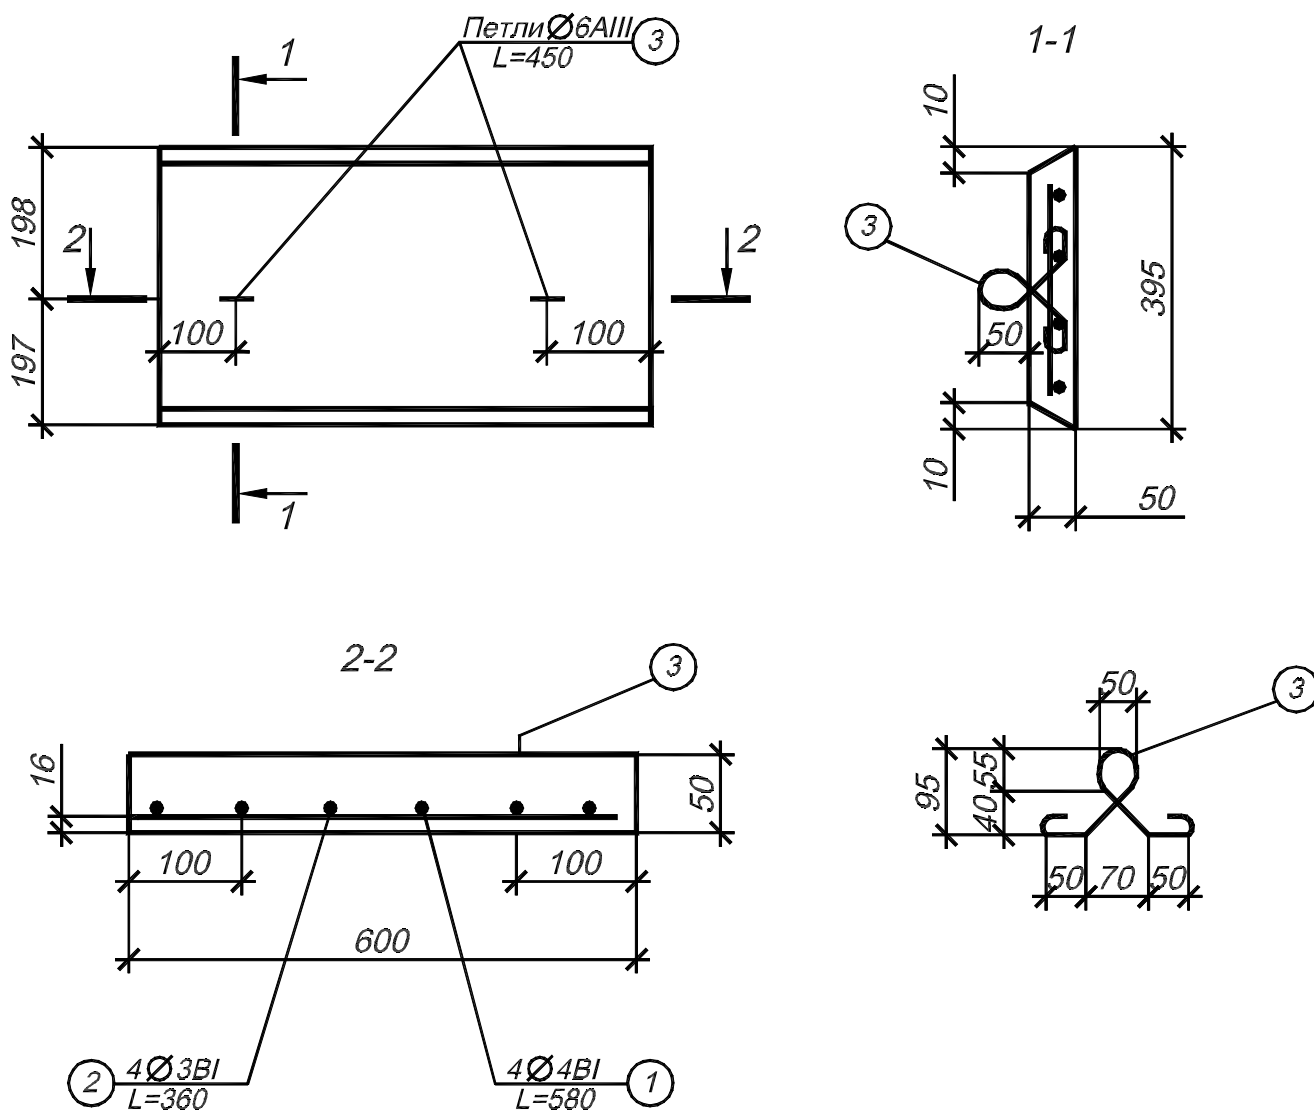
Варианты 16, 17, 18, 19, 20 задания «Железобетонные конструкции». Плиты БН-06
